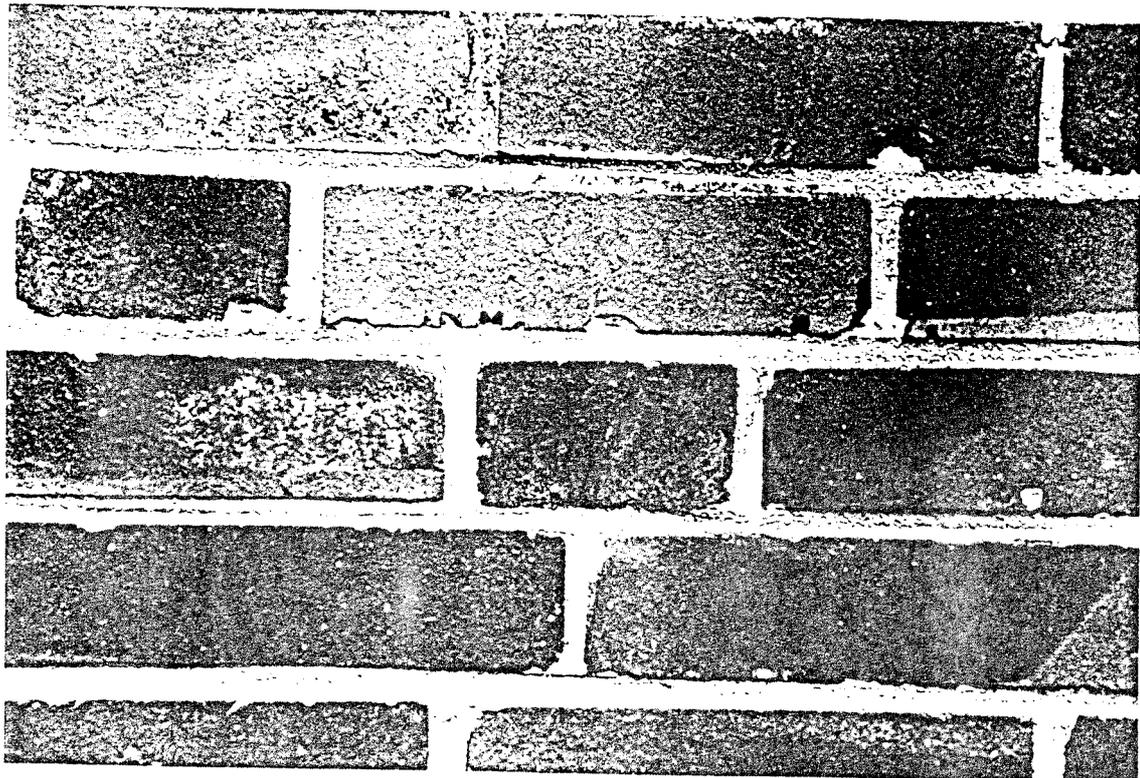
Detailaufnahme eines Sichtmauerwerksabschnittes von Gebäude A
